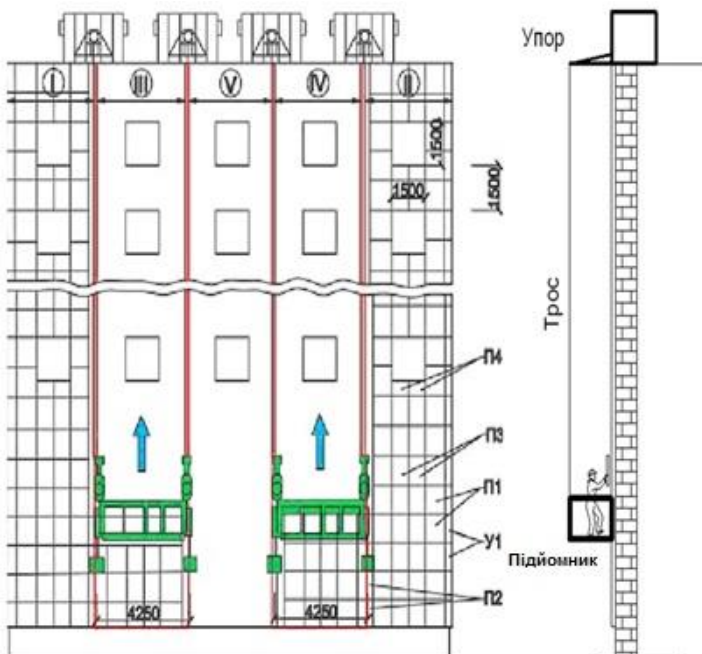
Схема розбивки фасаду на вертикальні захватки
